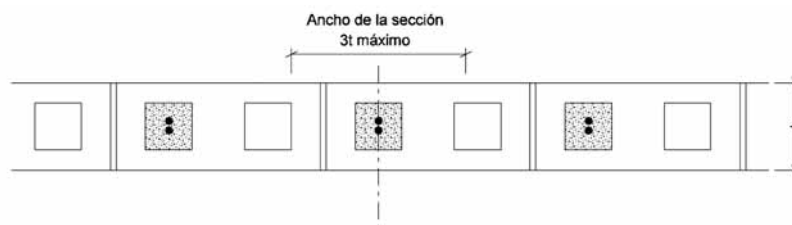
ANCHO DE LAS SECCIONES CON ARMADURAS CONCENTRADAS EN HUECOS
